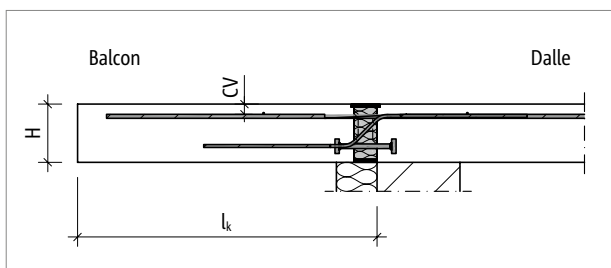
Schöck Isokorb® T Type K-M12 : Système statique
